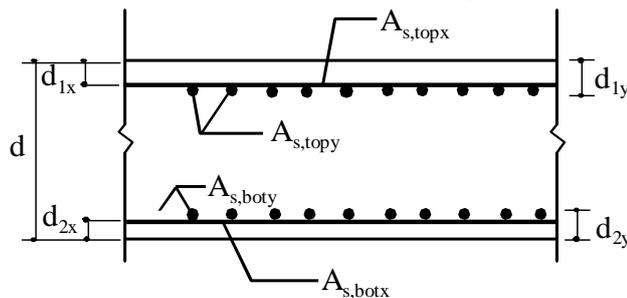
Schnittgeometrie und Bewehrung parallel zur x -Richtung
